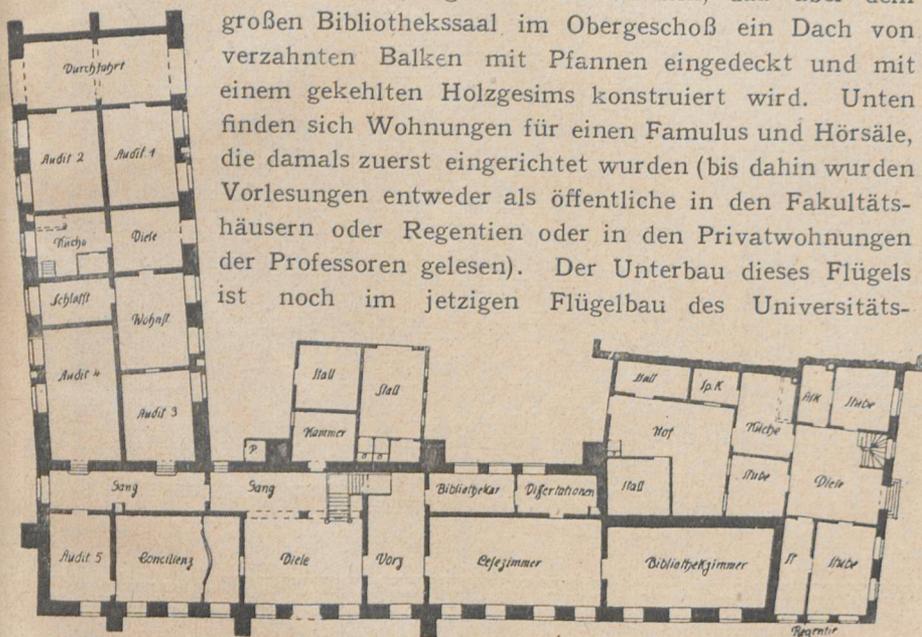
Weißes Kolleg 1858. Erdgeschoßgrundriß 1 : 400
